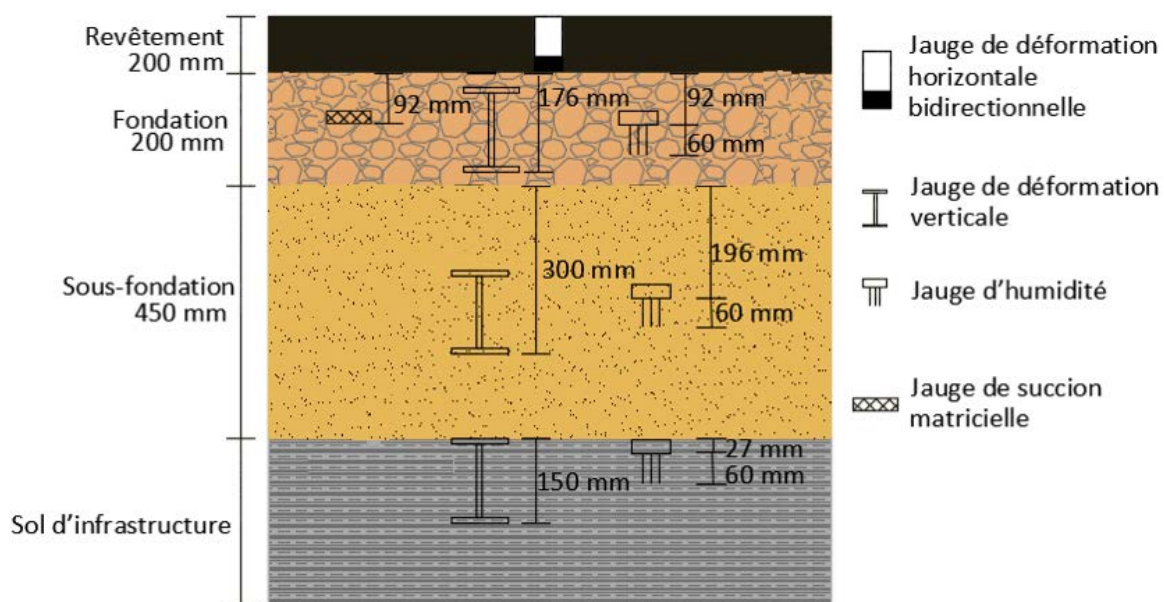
Instrumentation de la section 200 mm au SERUL
